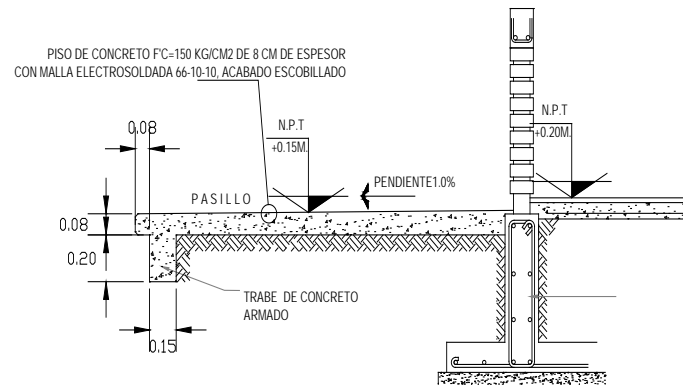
Detalle de la banqueta y la trabe ahogada en la fachada principal del aula.
